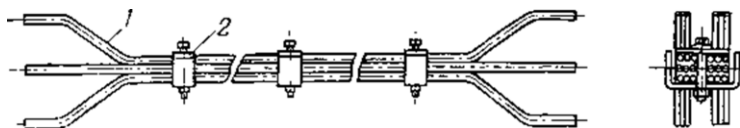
Бескаркасный трубный блок на пакетных обоймах (пакетный блок).
